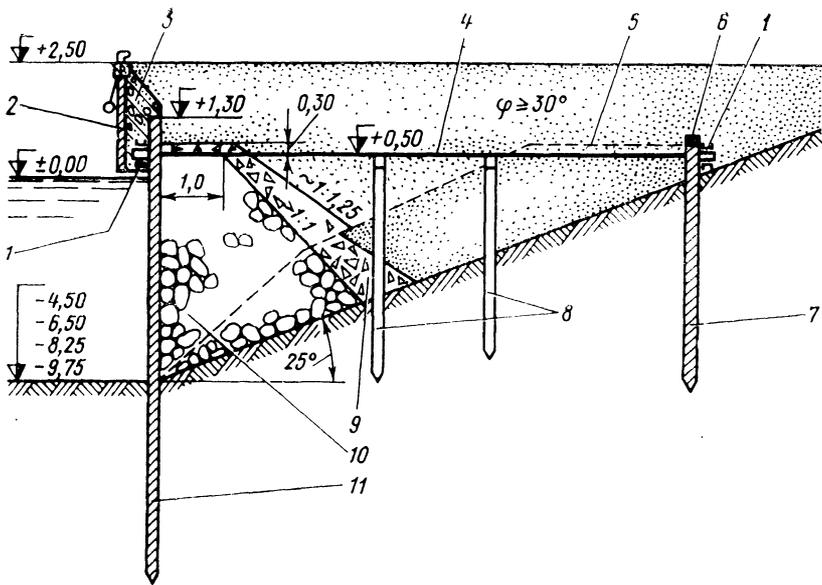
Больверк из прямоугольного железобетонного шпунта для морских условий:
